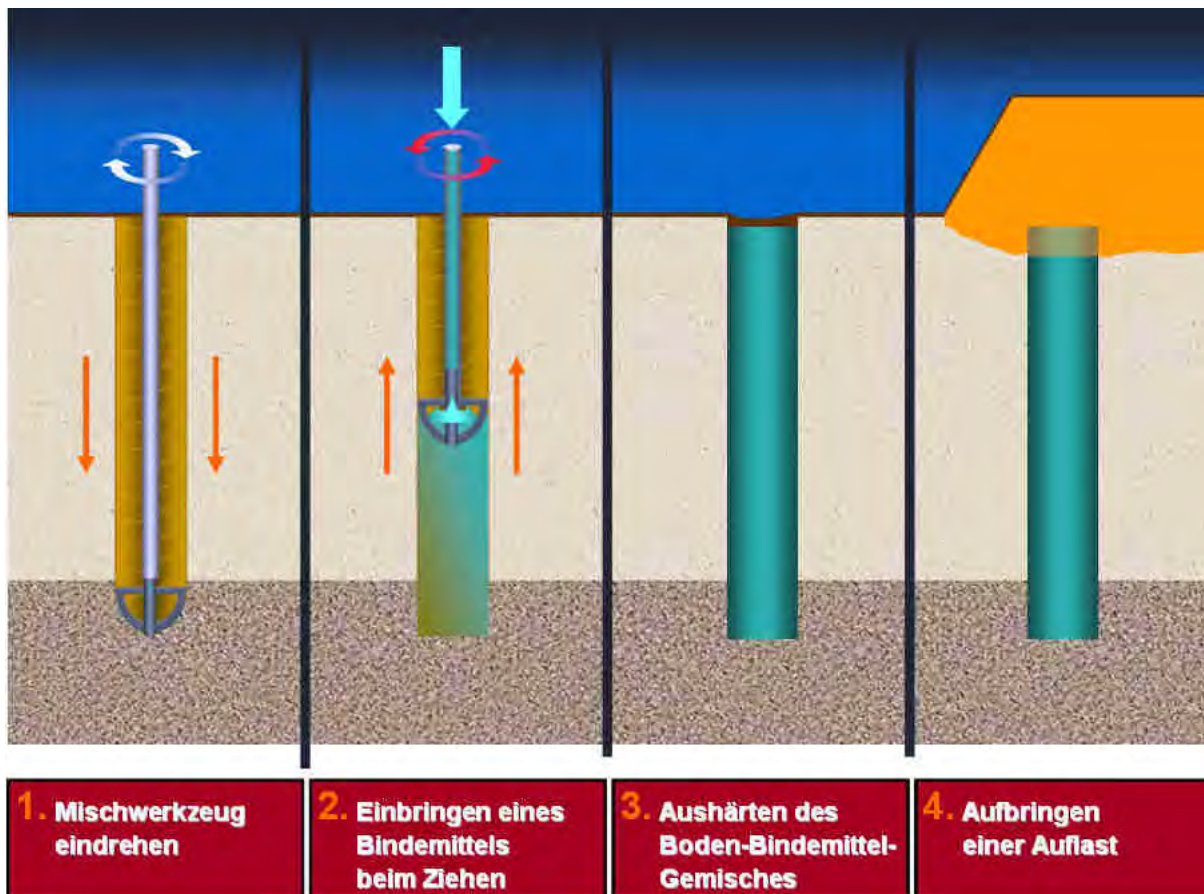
Herstellvorgang eines Baugrundverbesserungselements
